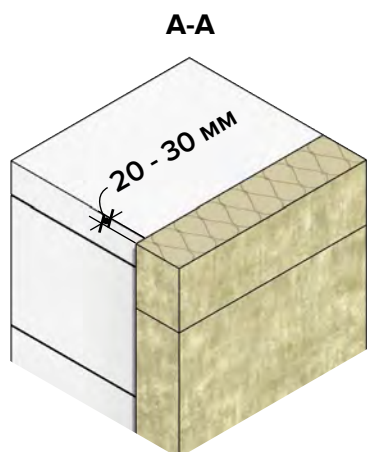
Монтаж теплоизоляционных плит вокруг проема
